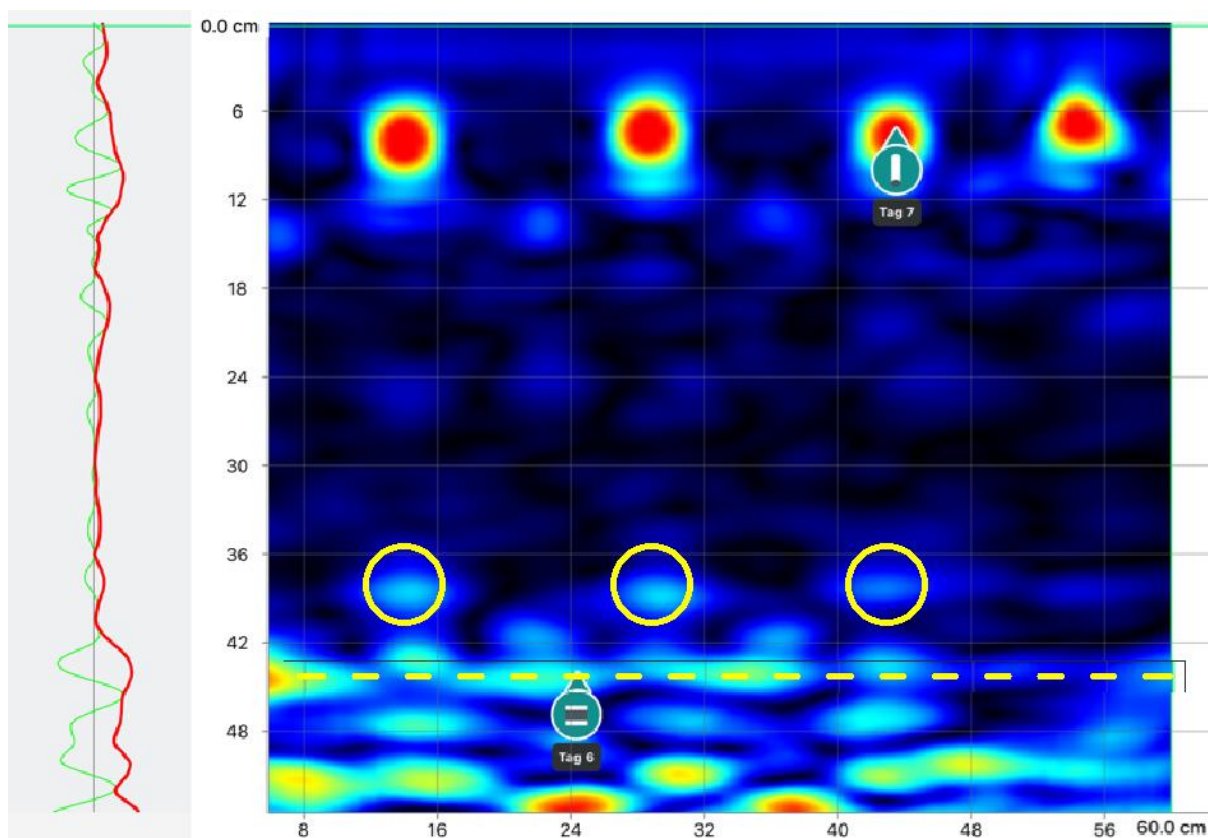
Plošný sken stojky pod trámem č. 2 doplněn dílčím B skenem. Zobrazeny jsou svislé pruty výztuže i vodorovné třmínky u povrchu betonu ze strany měření.
